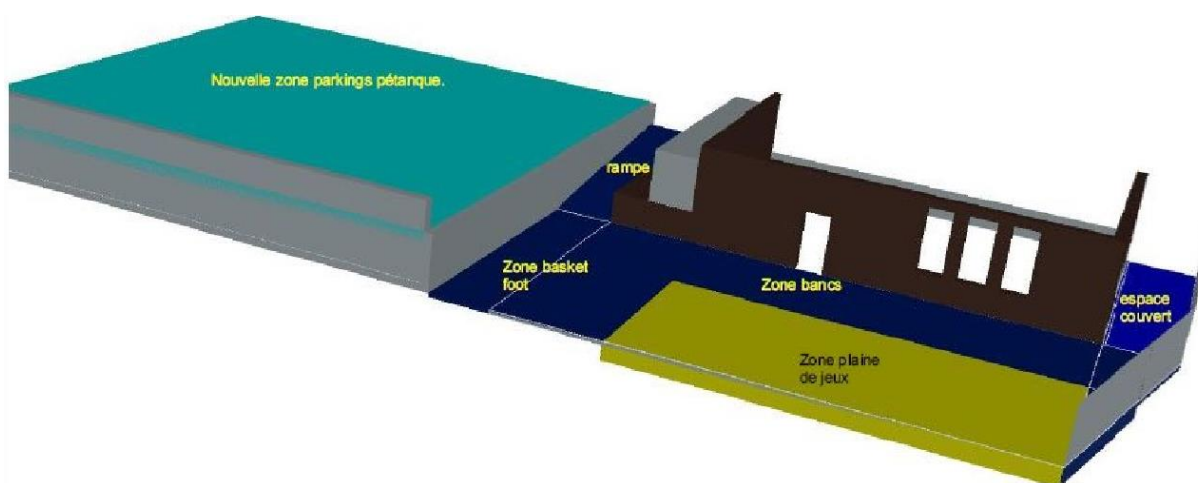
Esquisse de l'intervention (Source : Comité de village de Buissonville)
